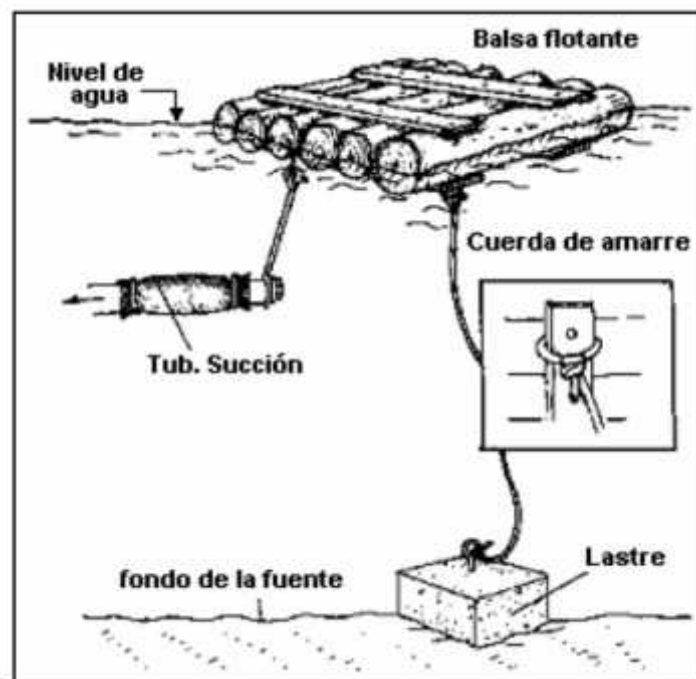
Flotadores, elementos de Fijación y tubería de succión.
